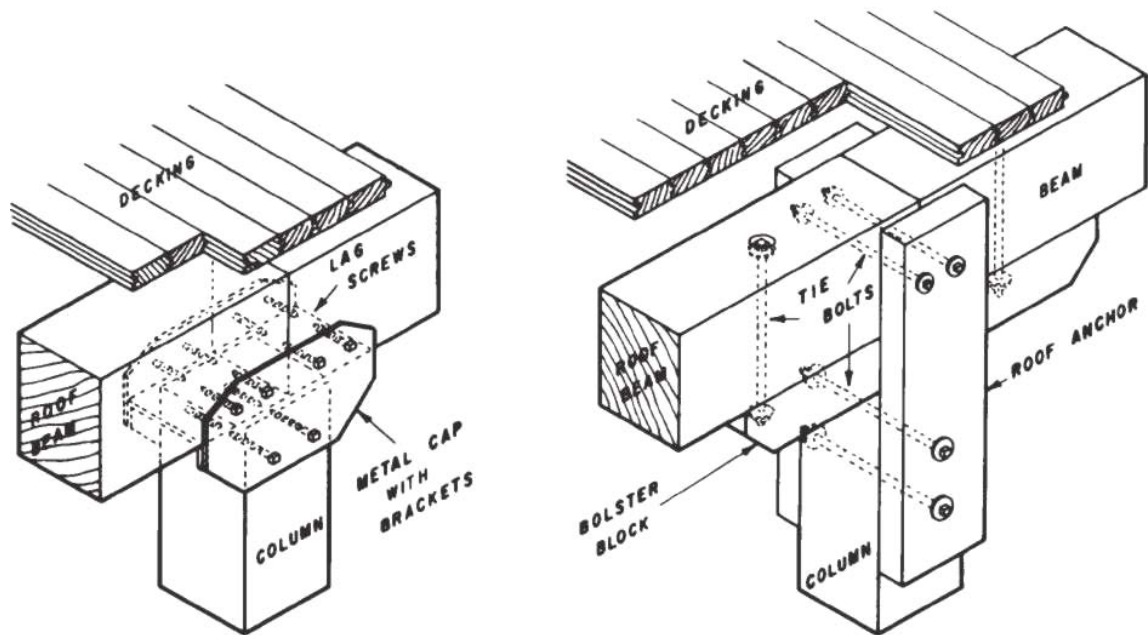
Algunos tipos de conectores vistos metálicos para unir viga con pilar
